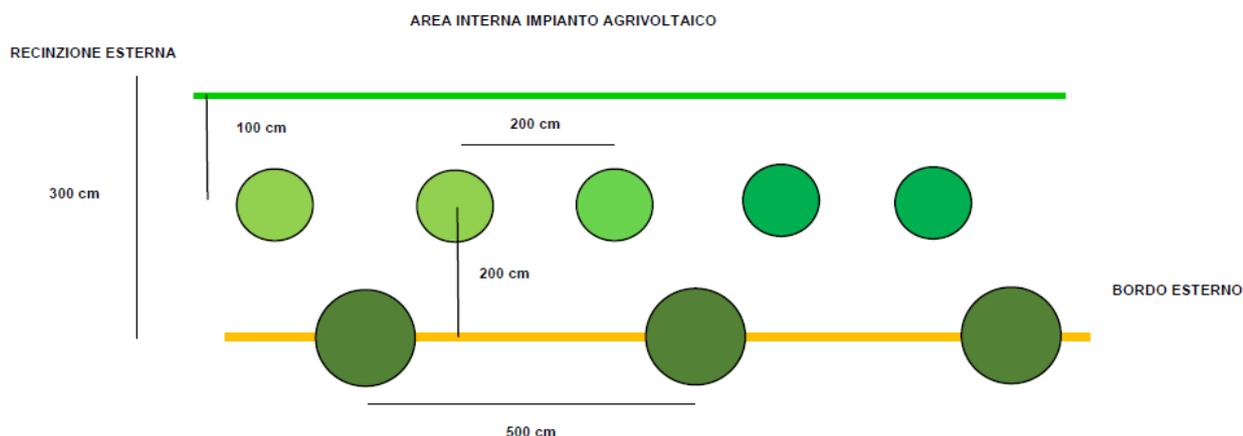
Siepe mista a doppia fila sfasata (planimetria di progetto)
